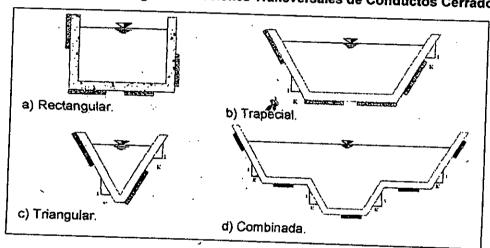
Secciones Transversales de Conductos Abiertos.
